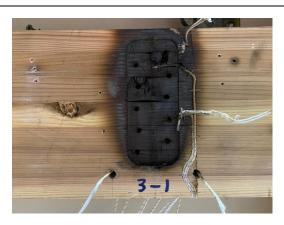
試験体 3-1 耐火構造壁内の梁(スギ集成材)表面
